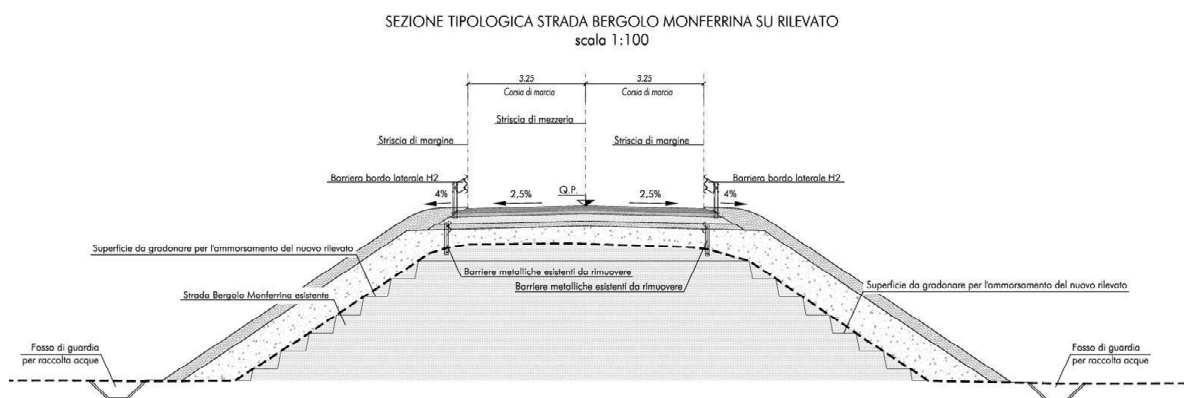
Strada Bergolo Monferrina - sezione tipo su rilevato
